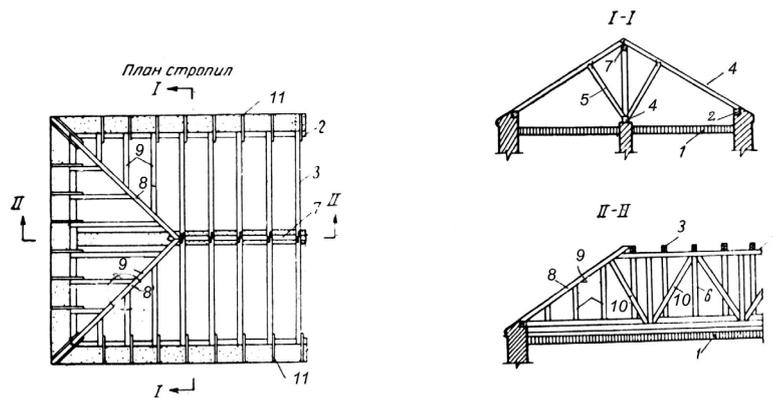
Конструктивные схемы деревянных наслонных стропил.
